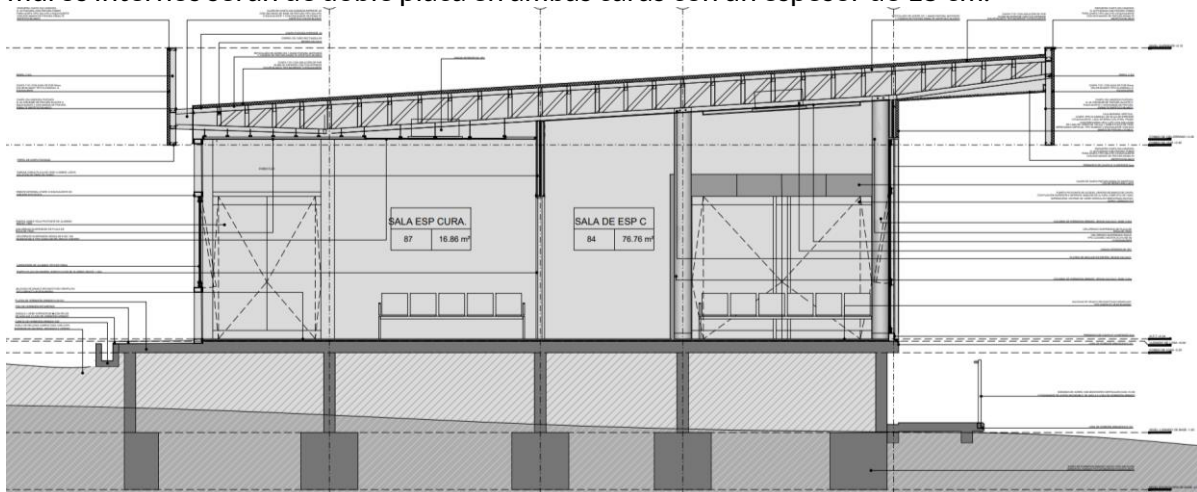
Corte de un pabellón. Fuente: Elaboración propia DAI-MIPIP.
